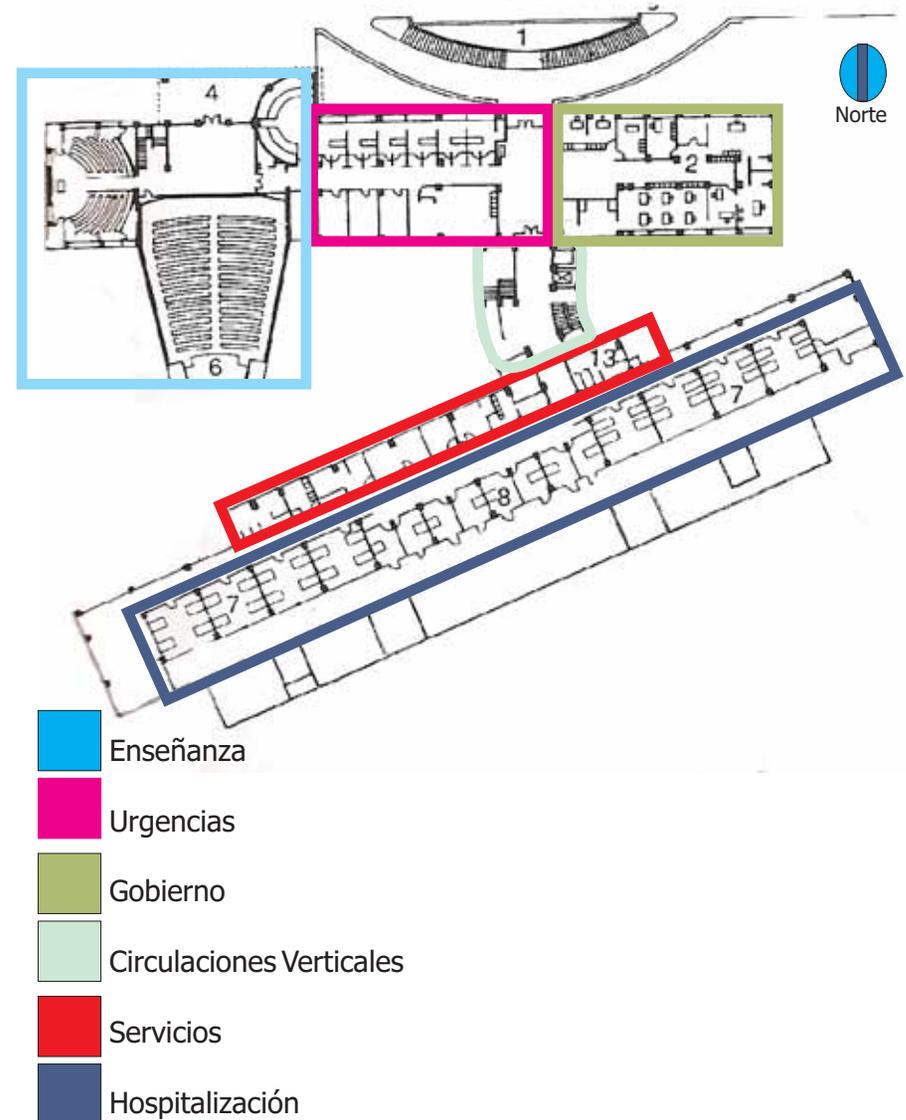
Planta primer nivel Instituto Nacional de Cardiología
